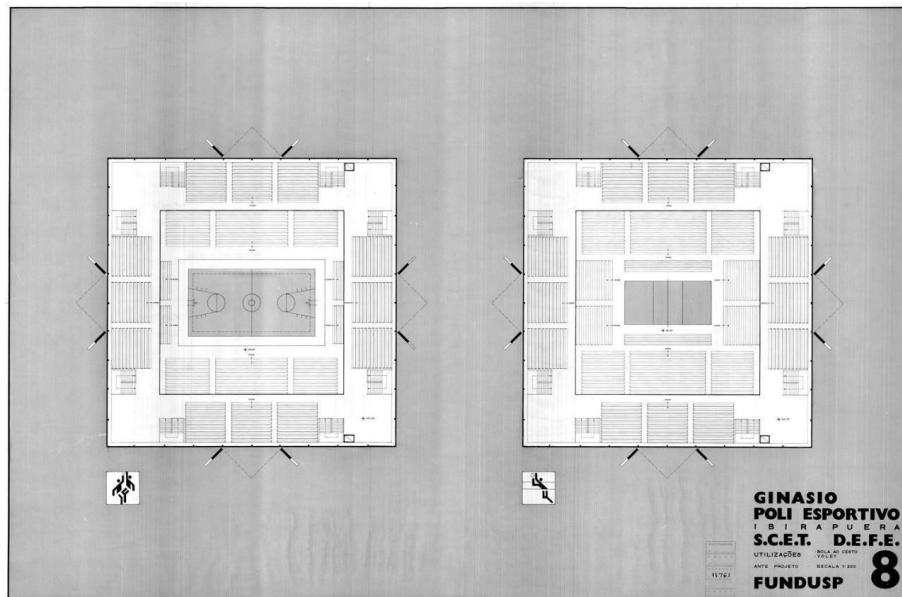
Plantas de opções de montagem das arquibancadas móveis, 1974 (SEF)
